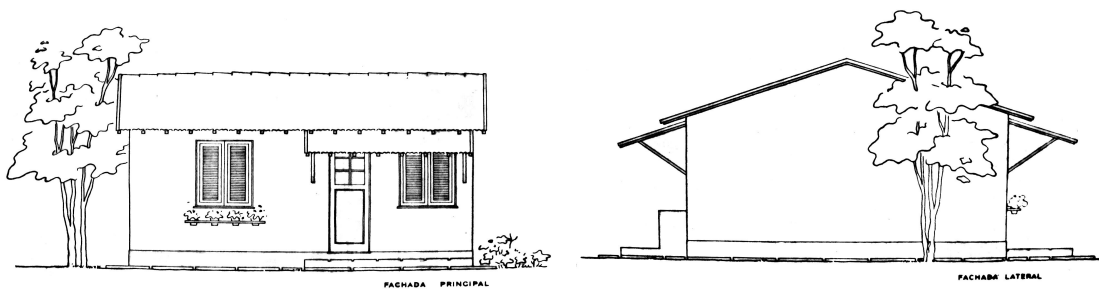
Estudo (a nanquim) das fachadas da tipologia F3. Fonte: arquivo INSS.
